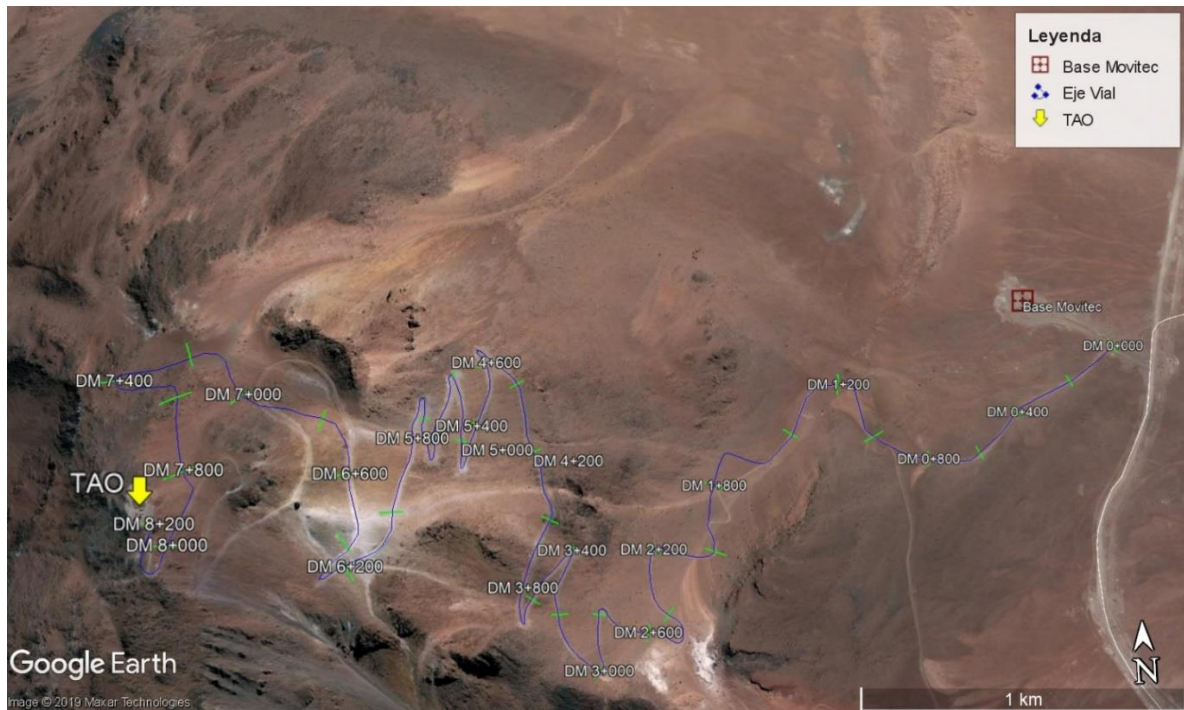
Vista en planta cerro Chajnantor y su camino de acceso.
